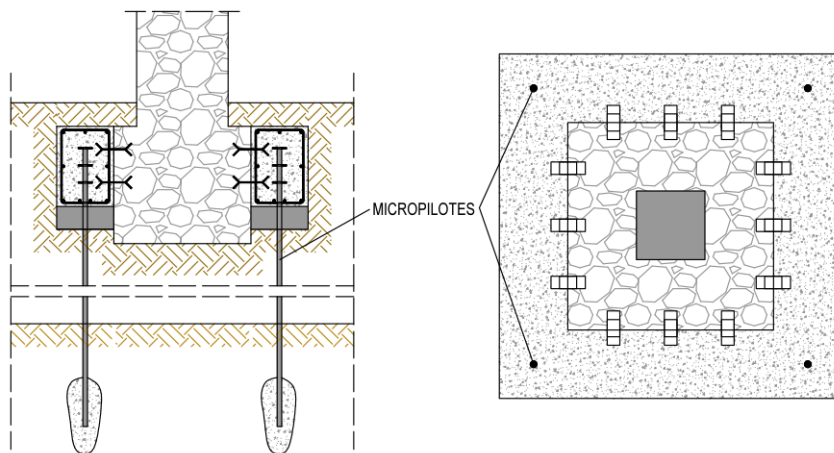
Refuerzo mediante micropilotes en zapata aislada. Fuente propia.
